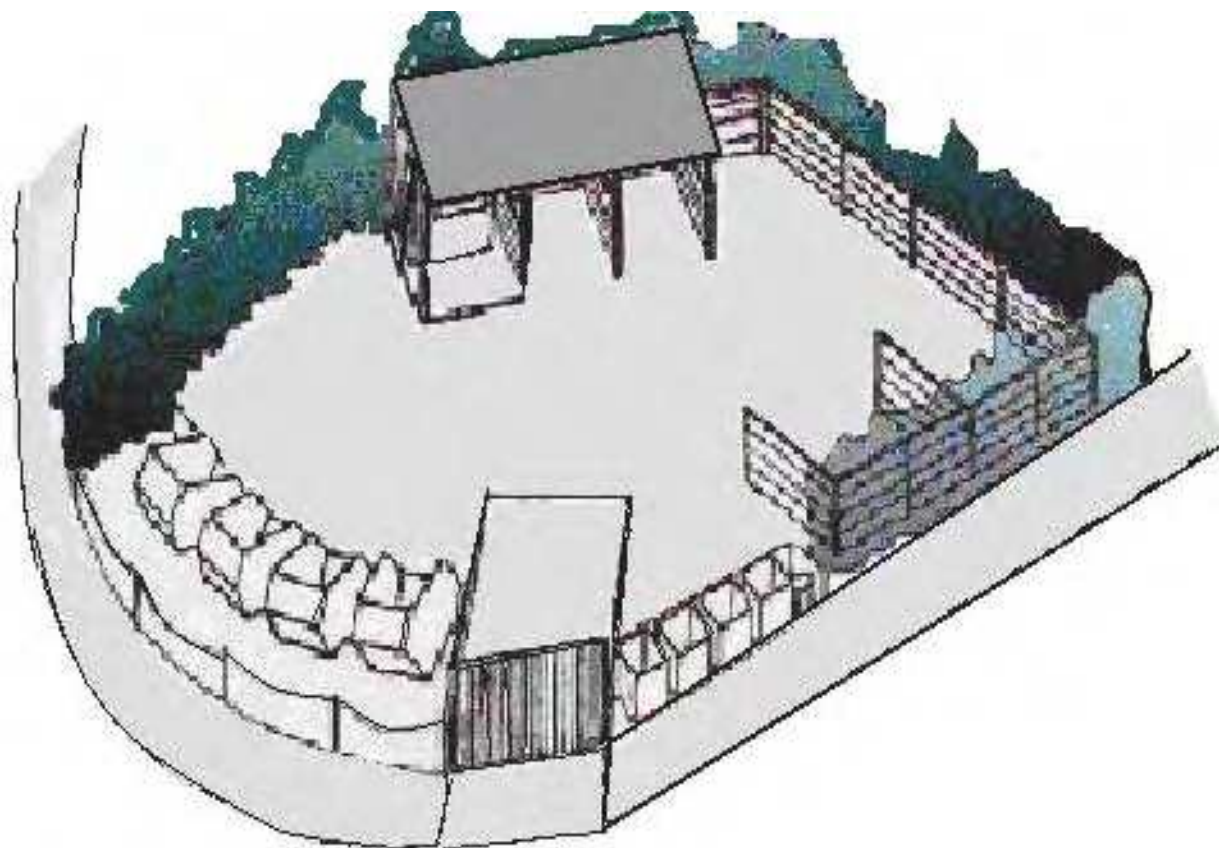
Modelo da planta de uma ATT em Guarulhos
